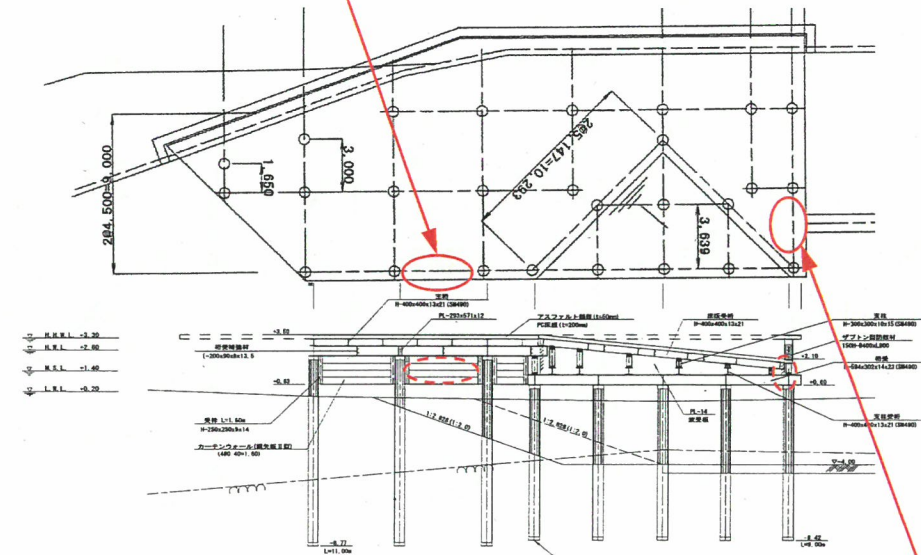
搬出入施設・車両乗降部 平面・横断面図 (カーテンウォール)
